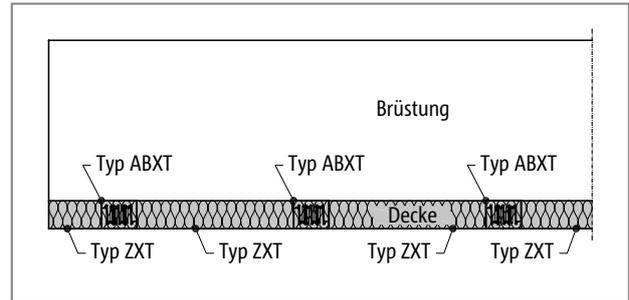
Schöck Isokorb® Typ ABXT horizontale Anordnung: Ansicht Brüstung vorgesetzt
